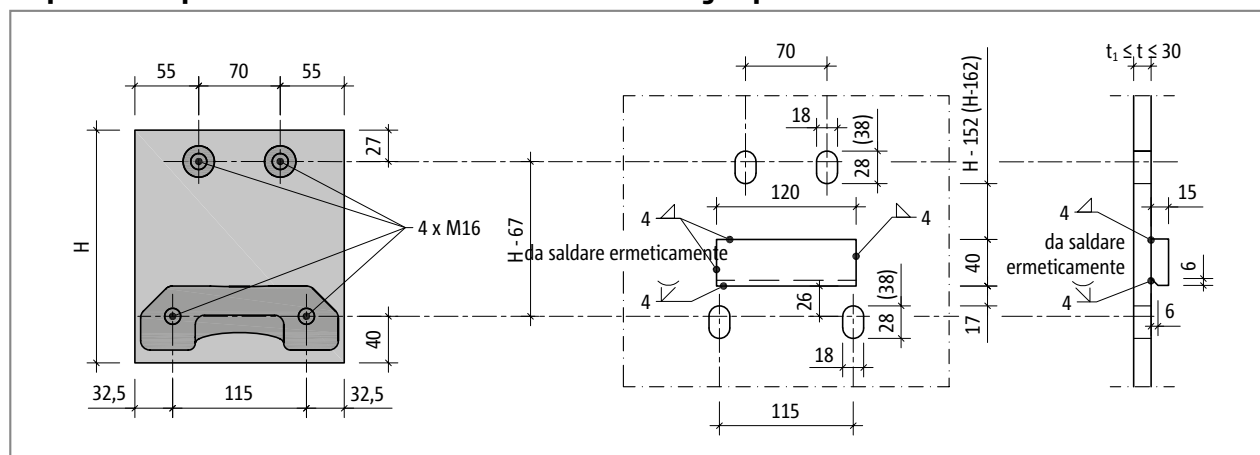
Schöck Isokorb® T tipo SKP-M1: costruzione del raccordo della piastra di testa
